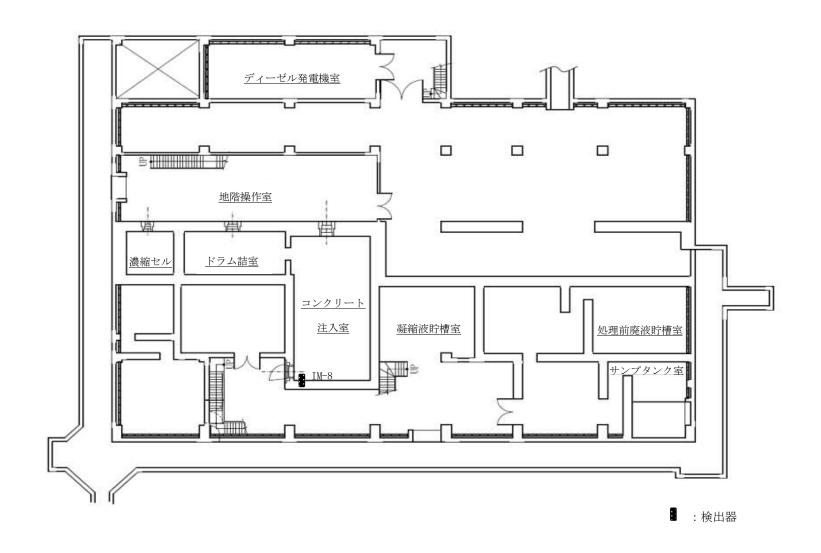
機器配置図(第2廃棄物処理棟 地階平面図)
